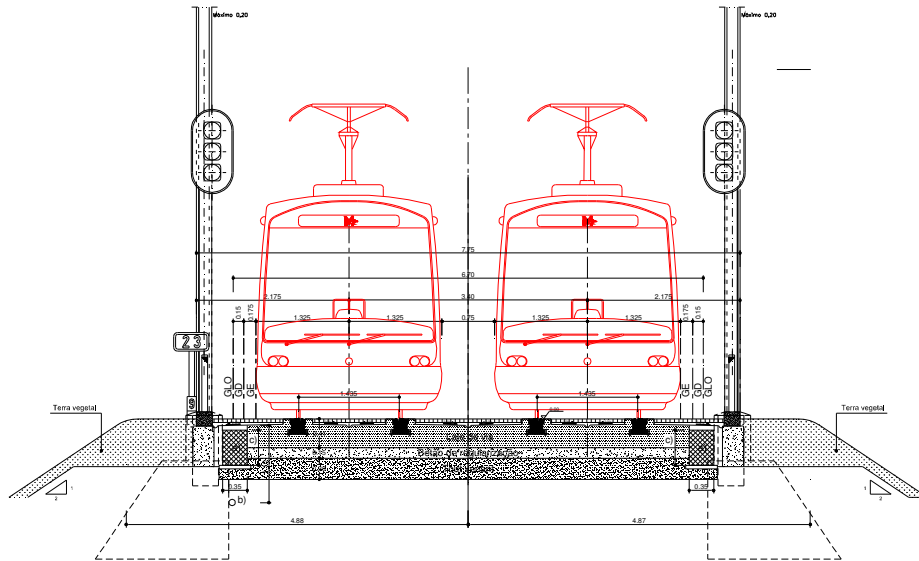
Via dupla betonada, em recta, em zona de aterro.
